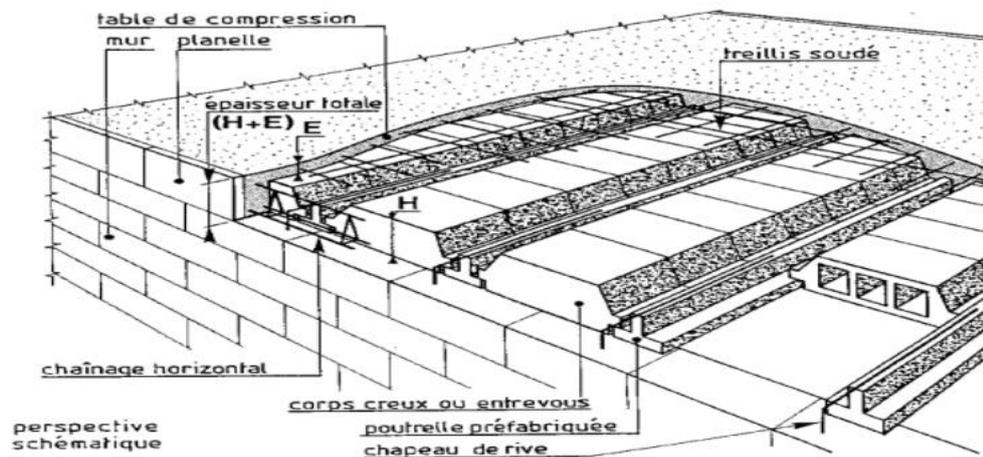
les éléments principaux d'un plancher à corps creux [67]
